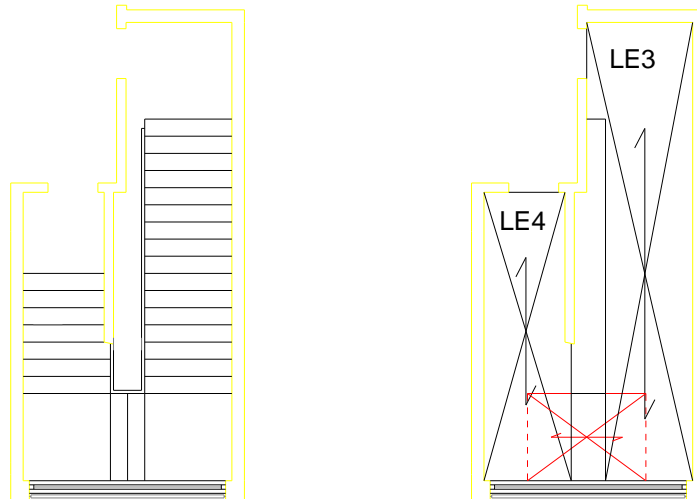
Planta de arquitetura e planta estrutural LE3 e LE4
